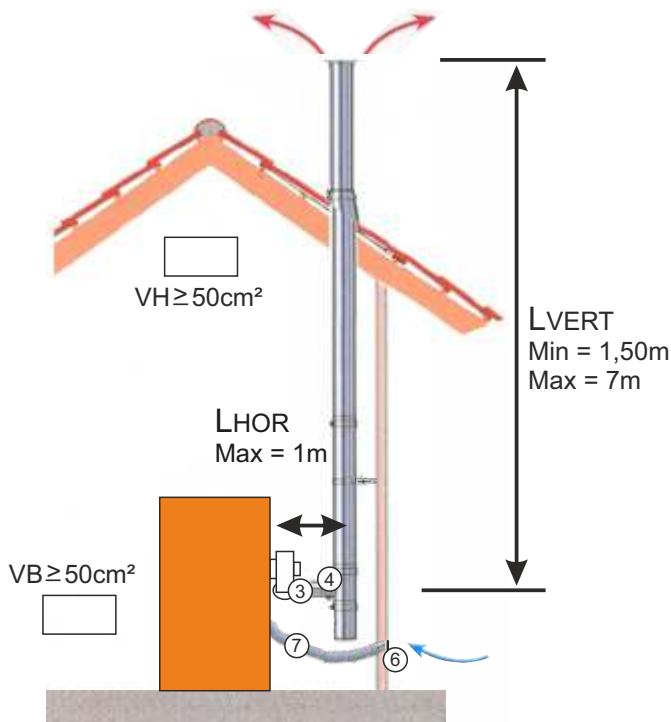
Air frais de la façade - grille murale, cheminée à l'intérieur de la chaufferie
